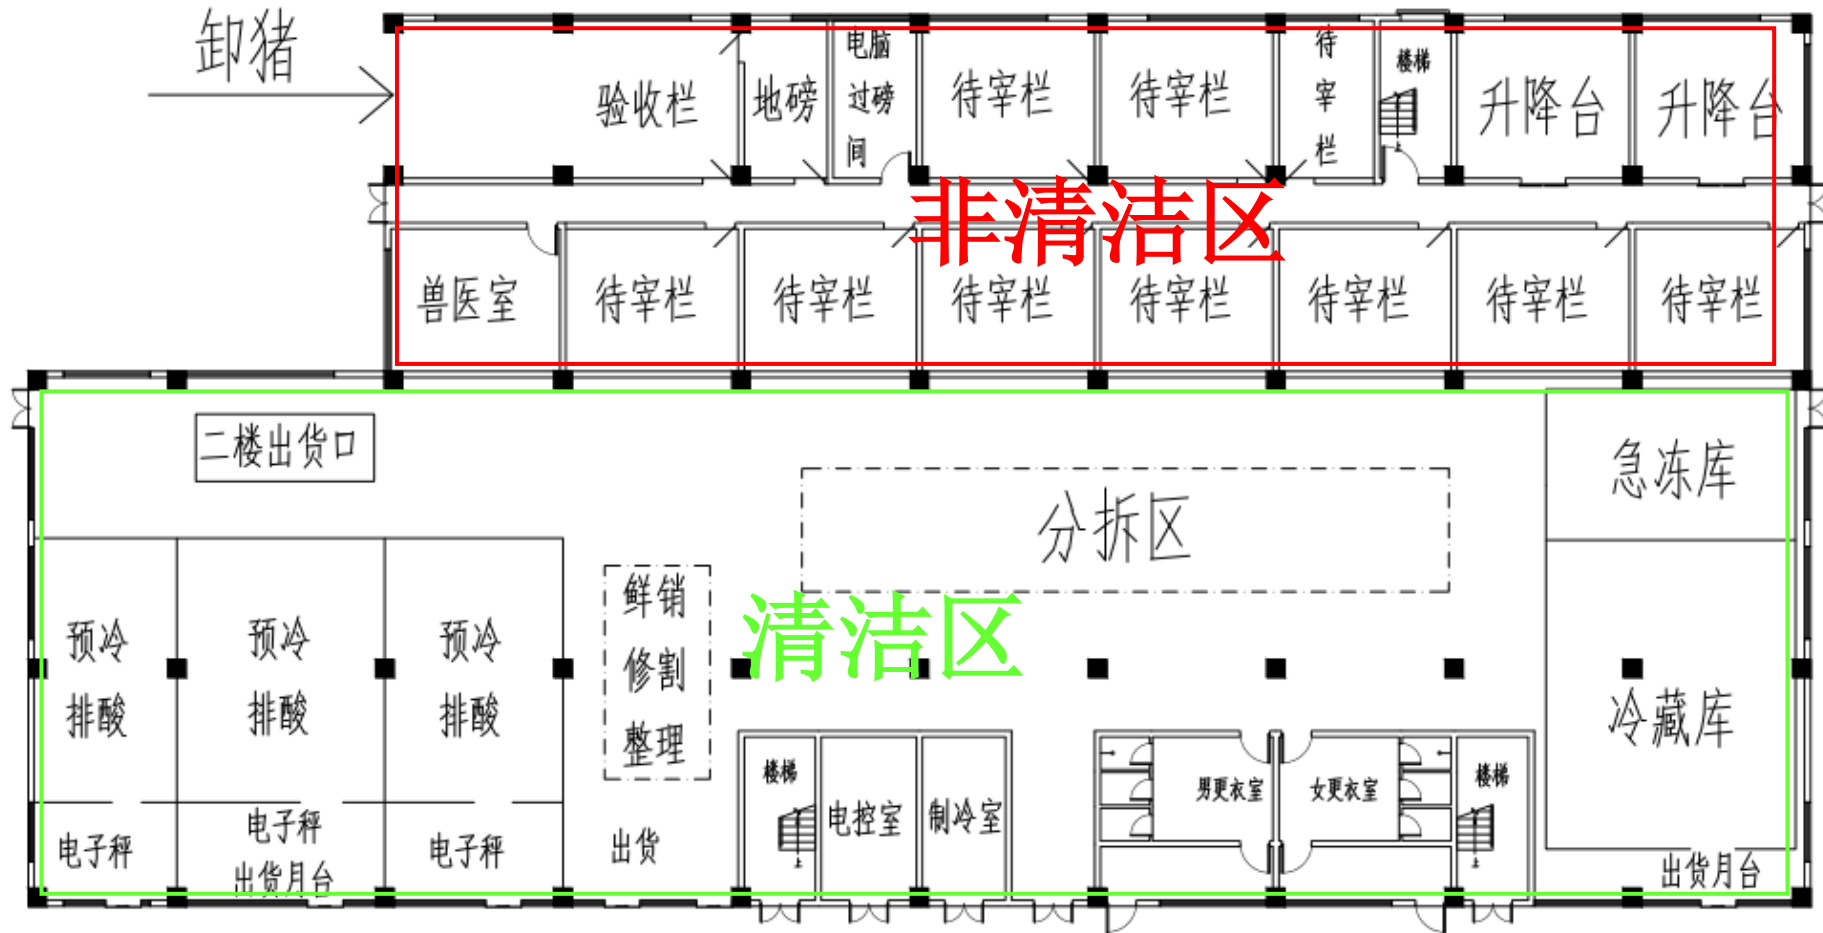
生猪屠宰车间 1 楼平面布置图
